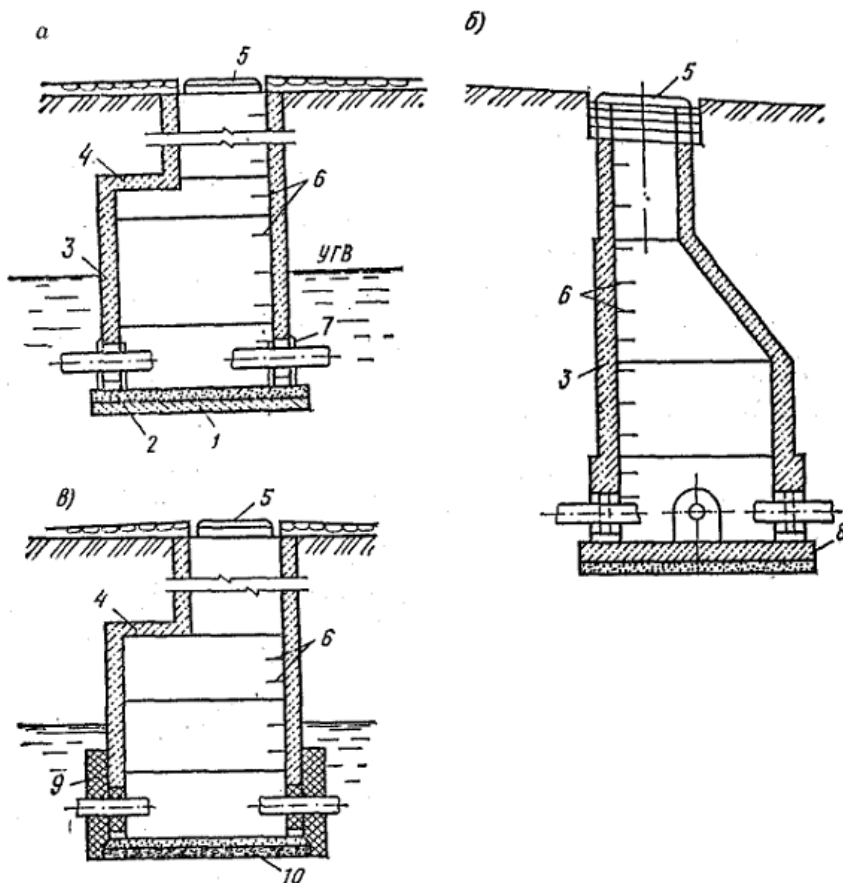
Збірний круглий (а, б) та прямокутний (в) залізобетонні колодязі, що влаштовуються у ґрунтах:
